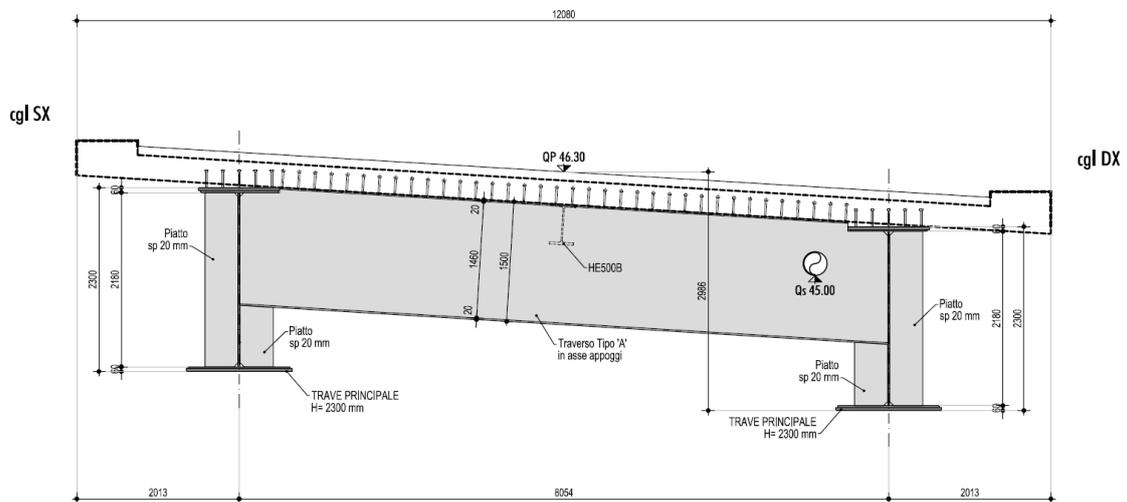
SEZIONE TRASVERSALE IMPALCATO SULLA SPALLA 1
